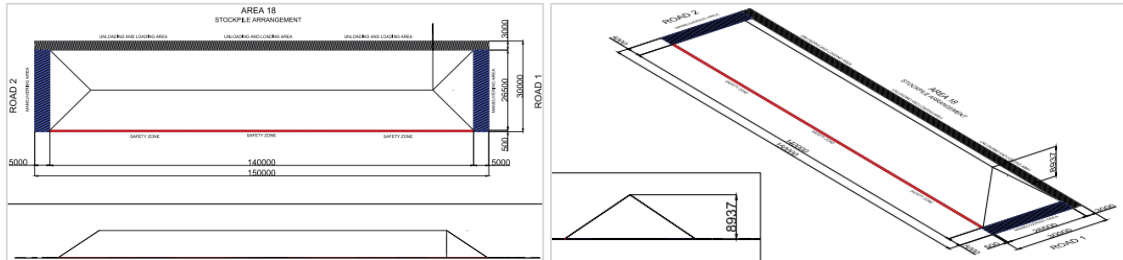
CONSTRUÇÃO DO PÁTIO.
